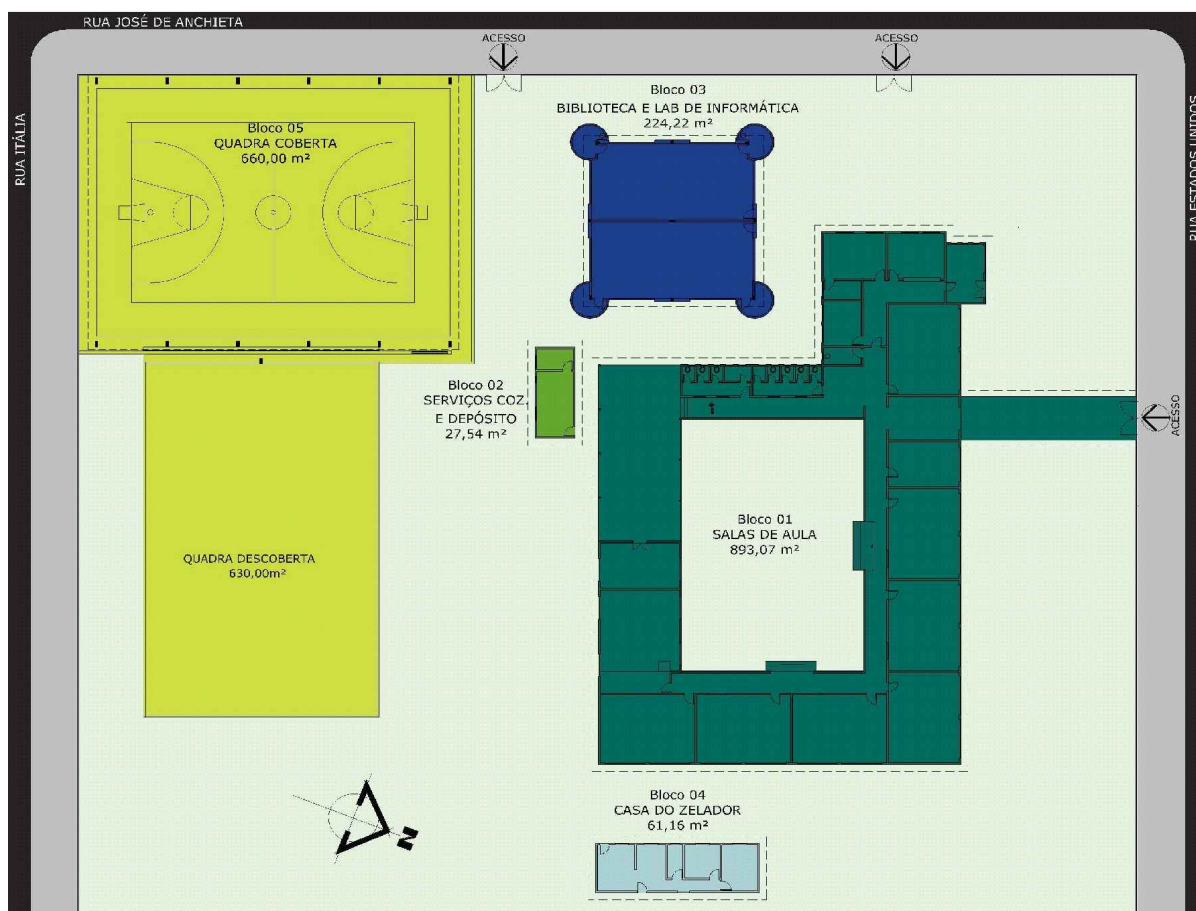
Planta Baixa Colégio Estadual Rainha da Paz
